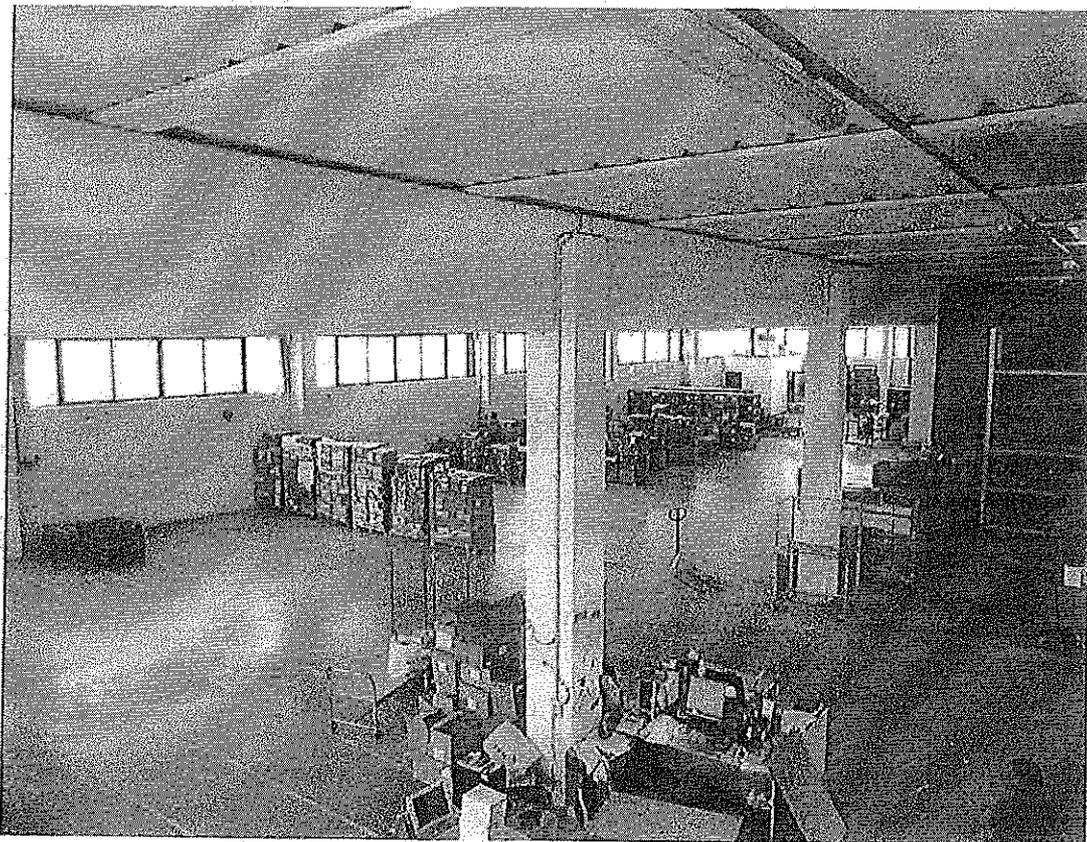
Corpo fabbrica produttivo – vista interna.
